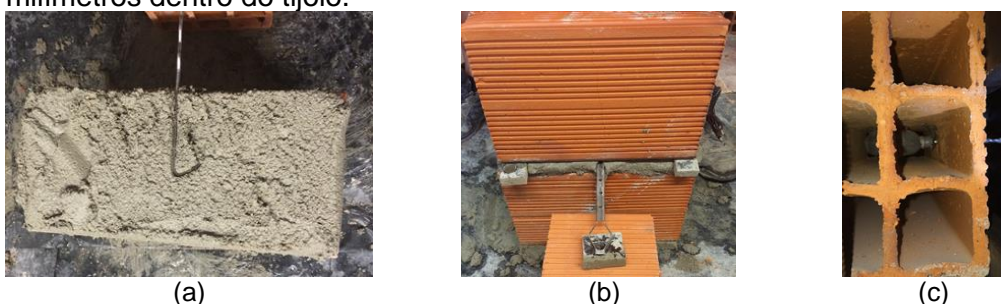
Construção dos provetes e aplicação dos ligadores: (a) na alvenaria de tijolo face à vista; (b) na alvenaria de enchimento e (c) no tijolo, sendo o ligador de tipologia T5
